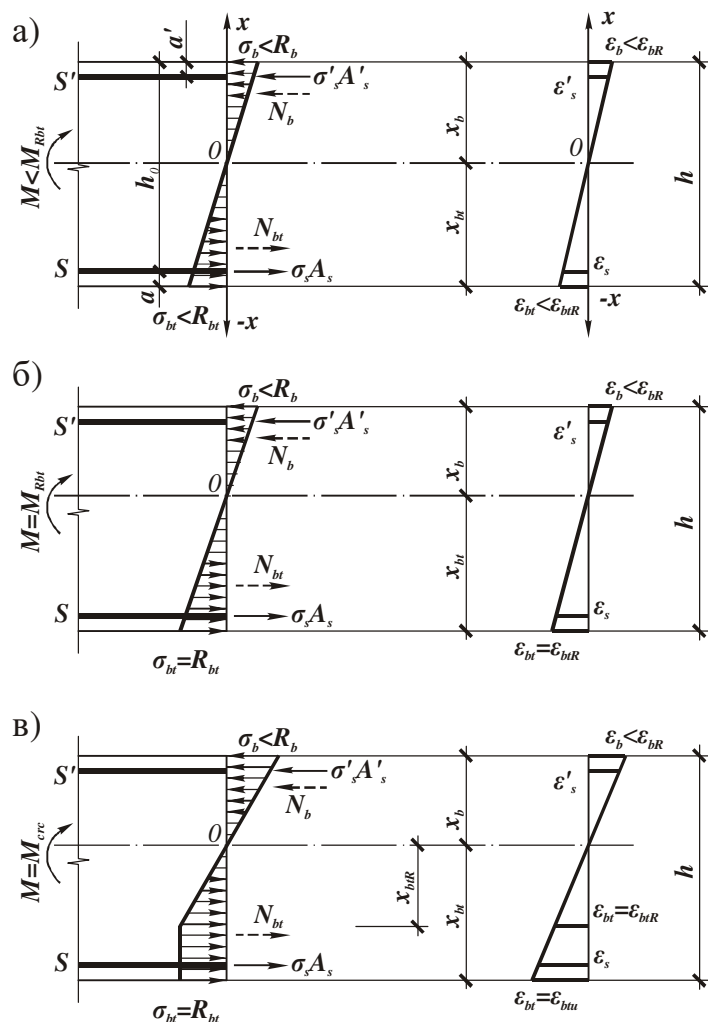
Напряженно-деформированное состояние железобетонного сечения на стадии I
